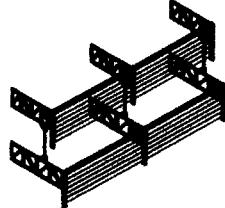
Gambar potongan detail dan perspektif shading barat 1
